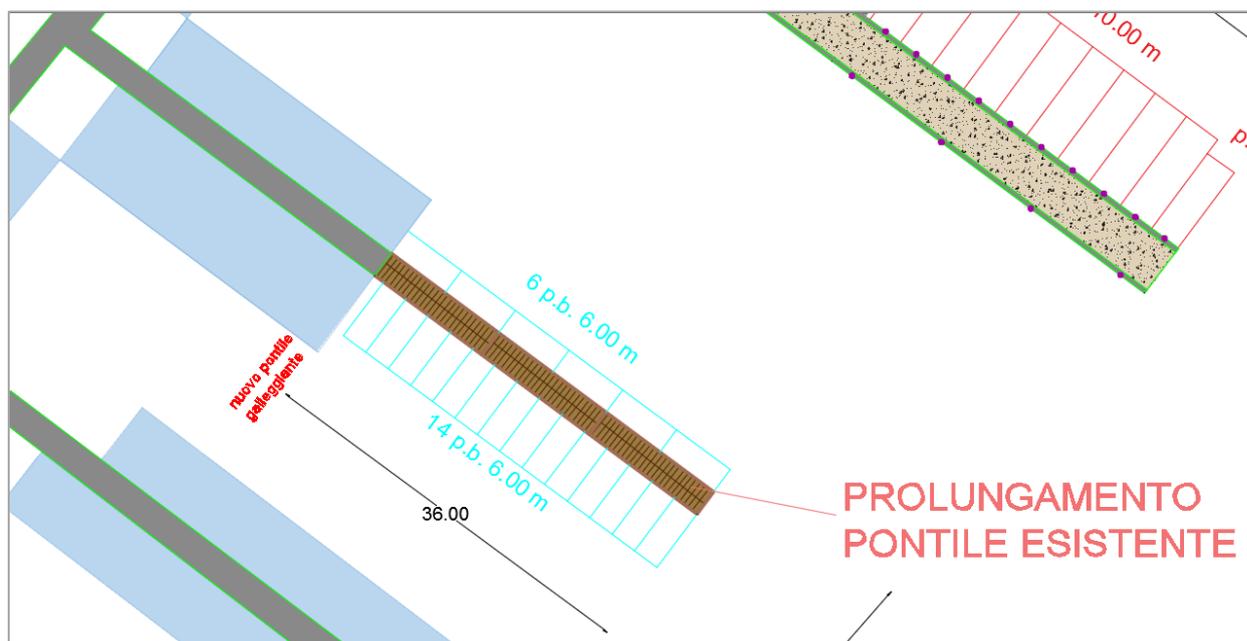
Stralcio planimetrico prolungamento pontile galleggiante
